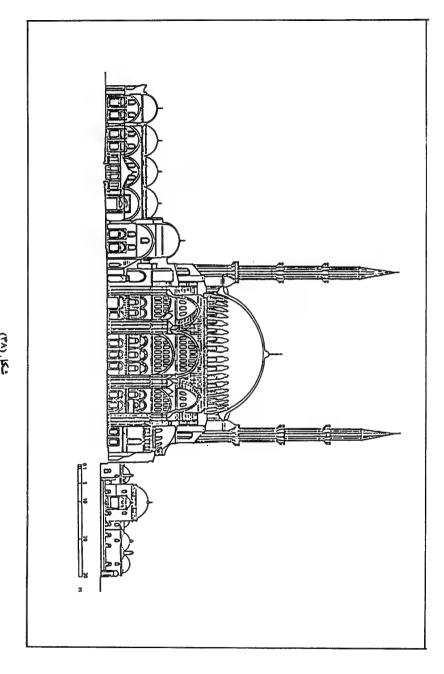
مسقط رأسي ومسقط أفقي لمسجد السلميانية باستانبول (من أعمال سنان باشا الممهار ـ القرن ١٠ هـ = ١٦ م)
